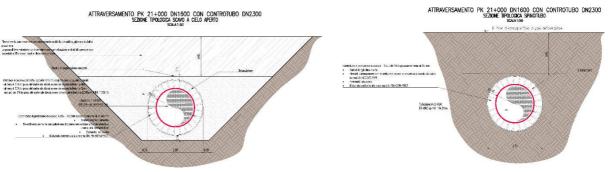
Attraversamento DN1600 pk 21+000 – Sezione Tipologica
